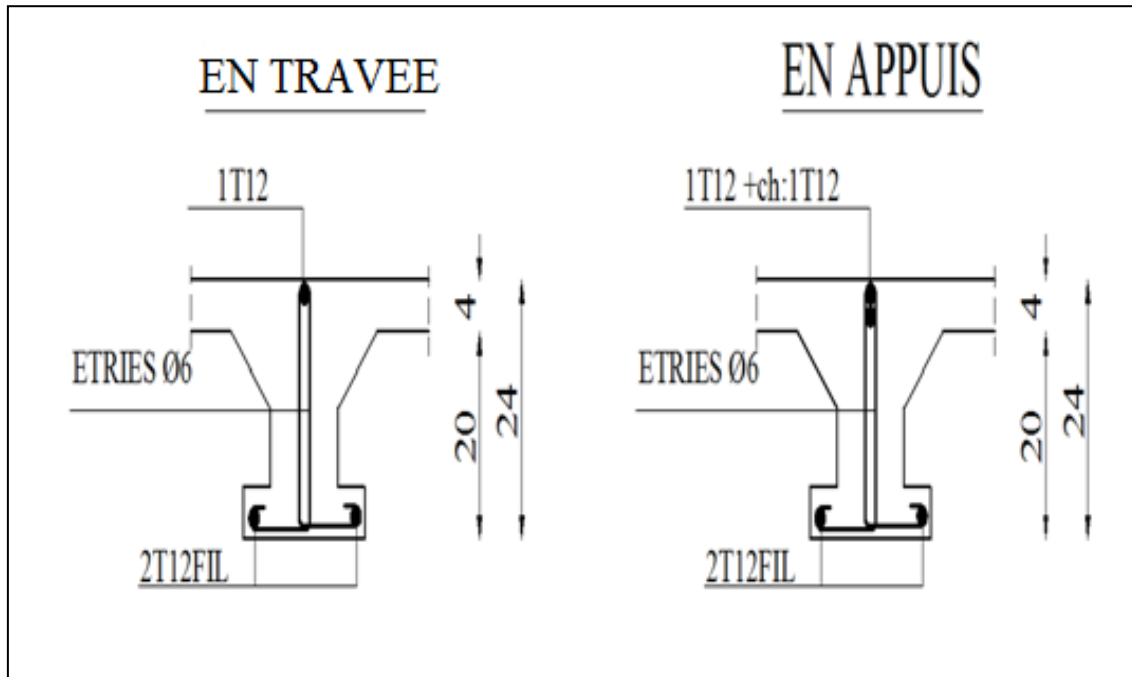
ferrailage de la poutrelle de plancher terrasse inaccessible et de plancher étage courante
